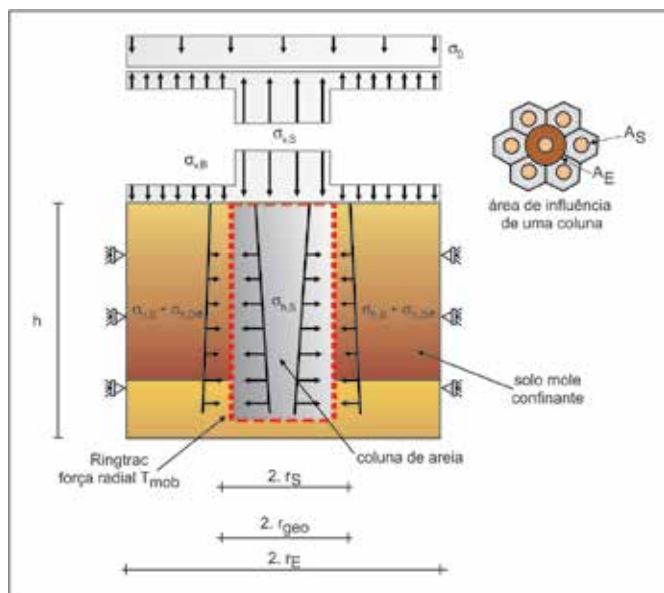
Modelo de cálculo e interpretações esquemáticas para o comportamento estrutural
